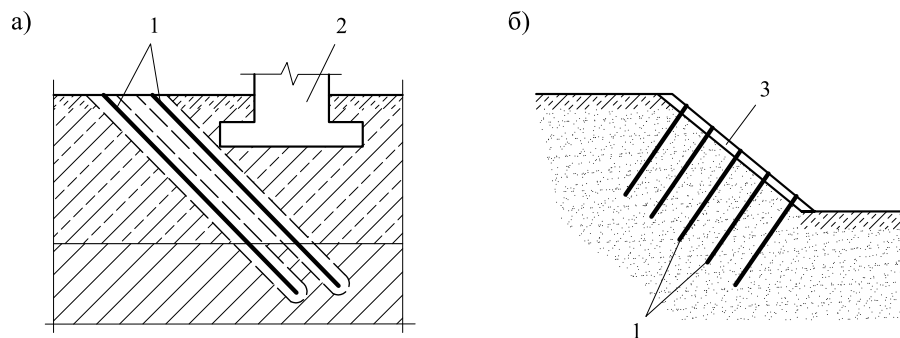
Схема підсилення основи похилими елементами: а – під фундаментом будівлі; б – схилу; 1 – армувальні елементи; 2 – фундамент; 3 – облицювання
